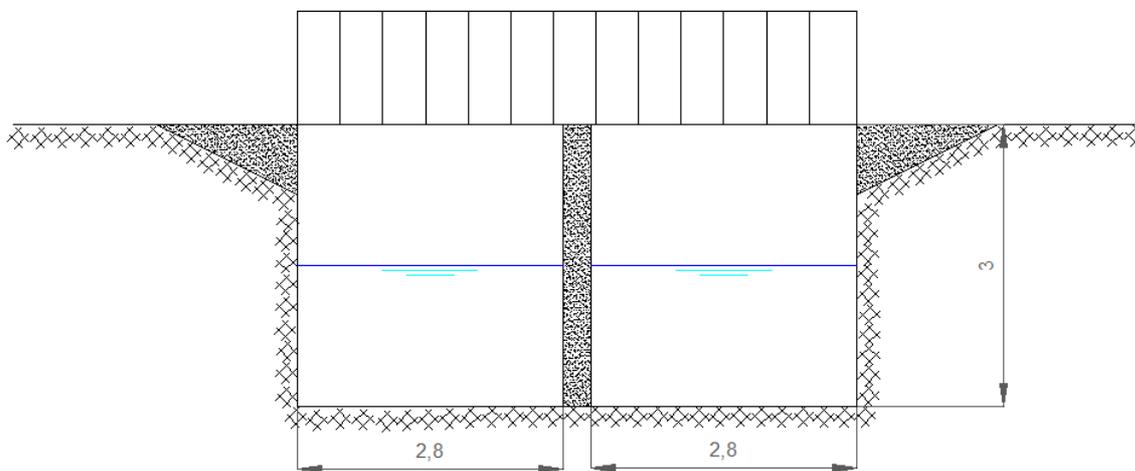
Seção Transversal 2 de canal no Córrego dos Palmitos
